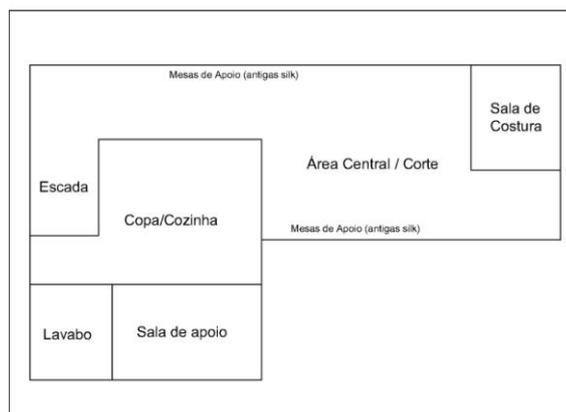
Planta em croqui da fabriqueta de roupas. Fonte: Elaborado pelos autores.
